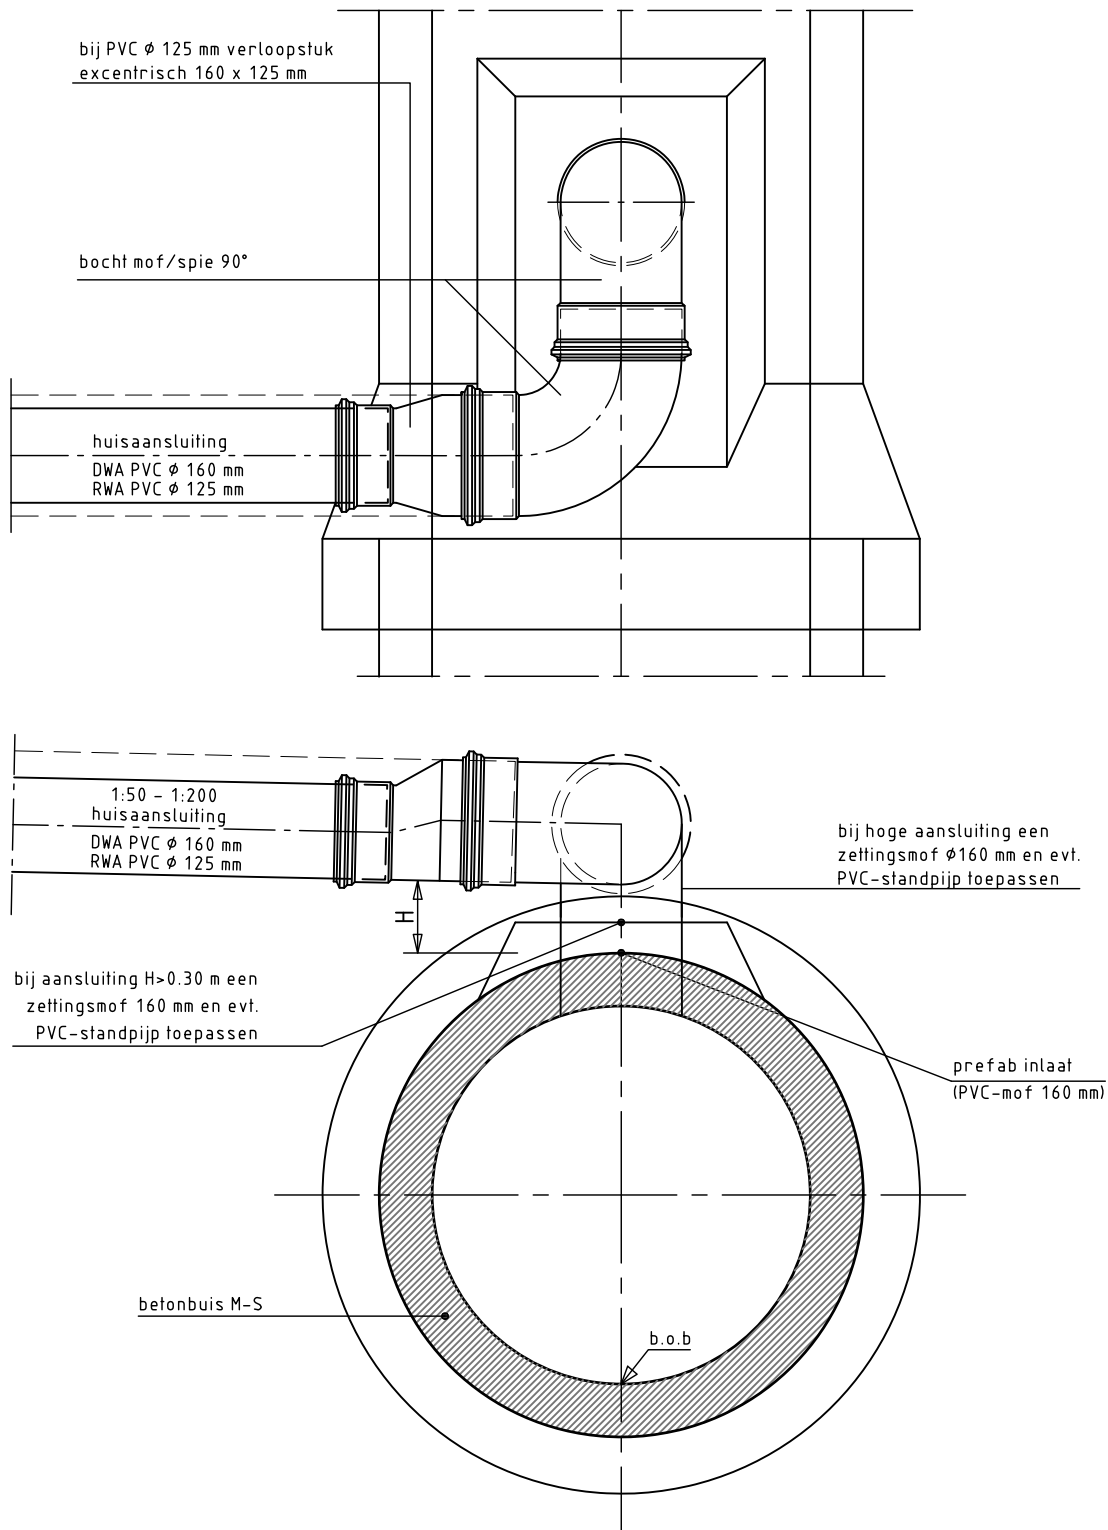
DETAIL BOVENAANSLUITING OP PVC-RIOLERING
